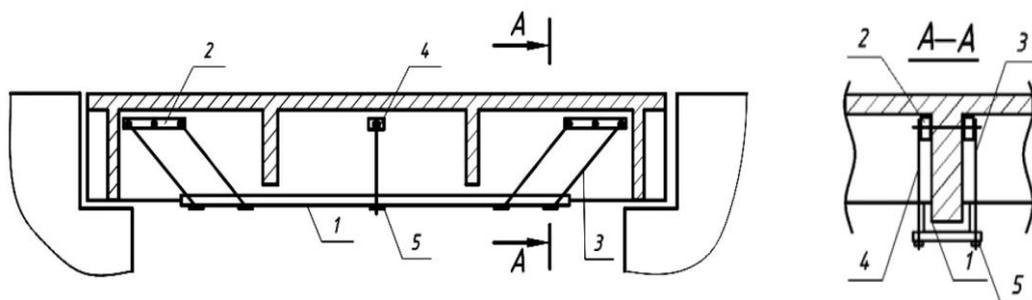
Усиление балок наклеиванием на них металлических элементов эпоксидным клеем: 1 – швеллер усиления; 2 – металлические полосы усиления; 3 – напрягаемые тяги; 4 – болты крепления; 5 – гайки регулирования напряжения в тягах (прижатия швеллера)
